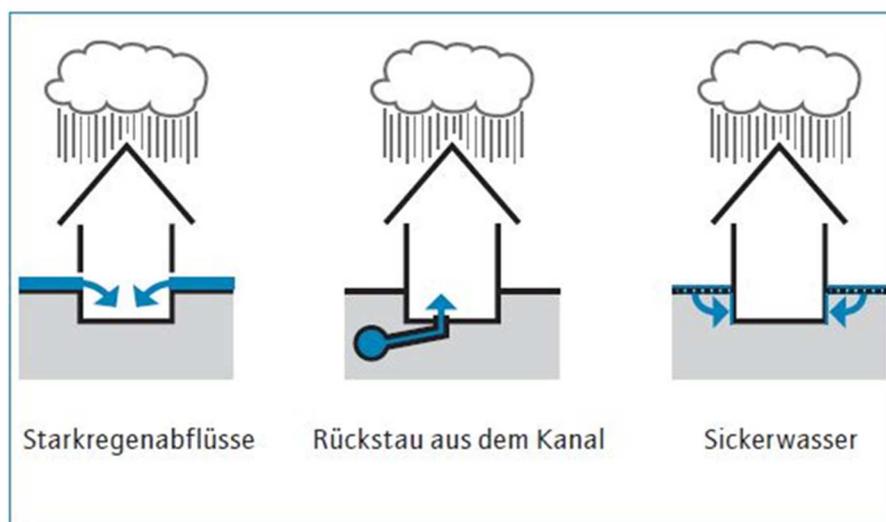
Überflutungsgefahren bei Starkregen (Quelle: StEB Köln | Wassersensibel planen und bauen in Köln)
